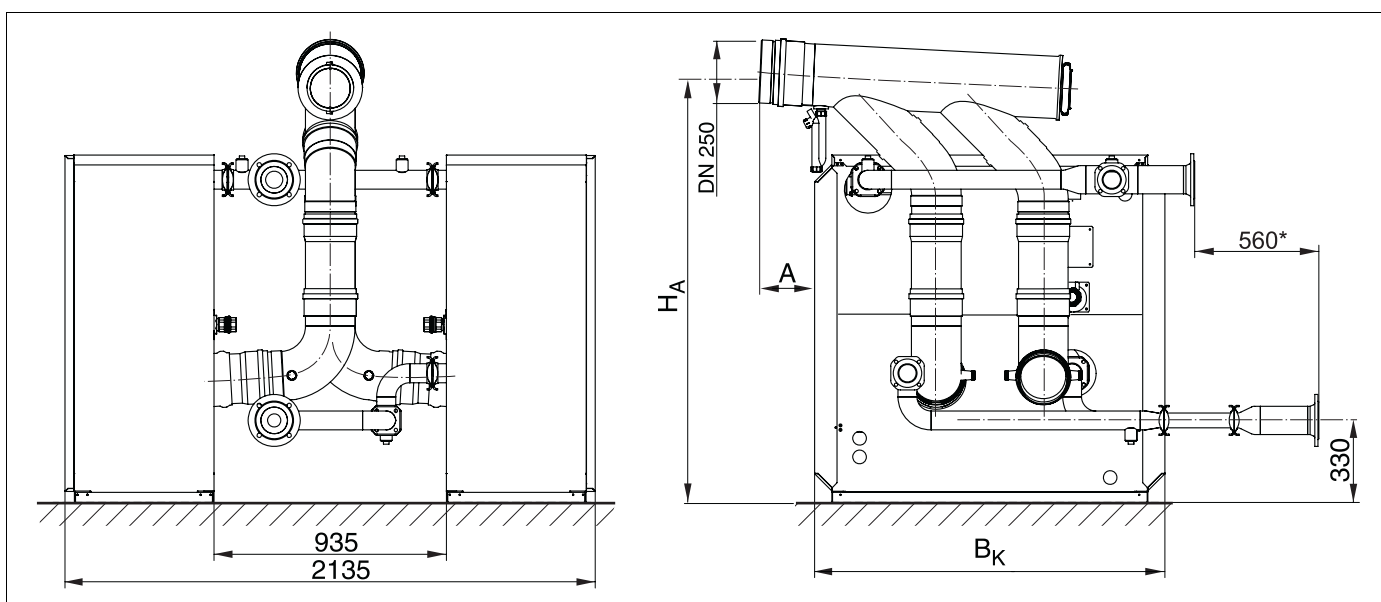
Размеры каскадного коллектора дымовых газов котла GB312 (400 - 560 кВт)
